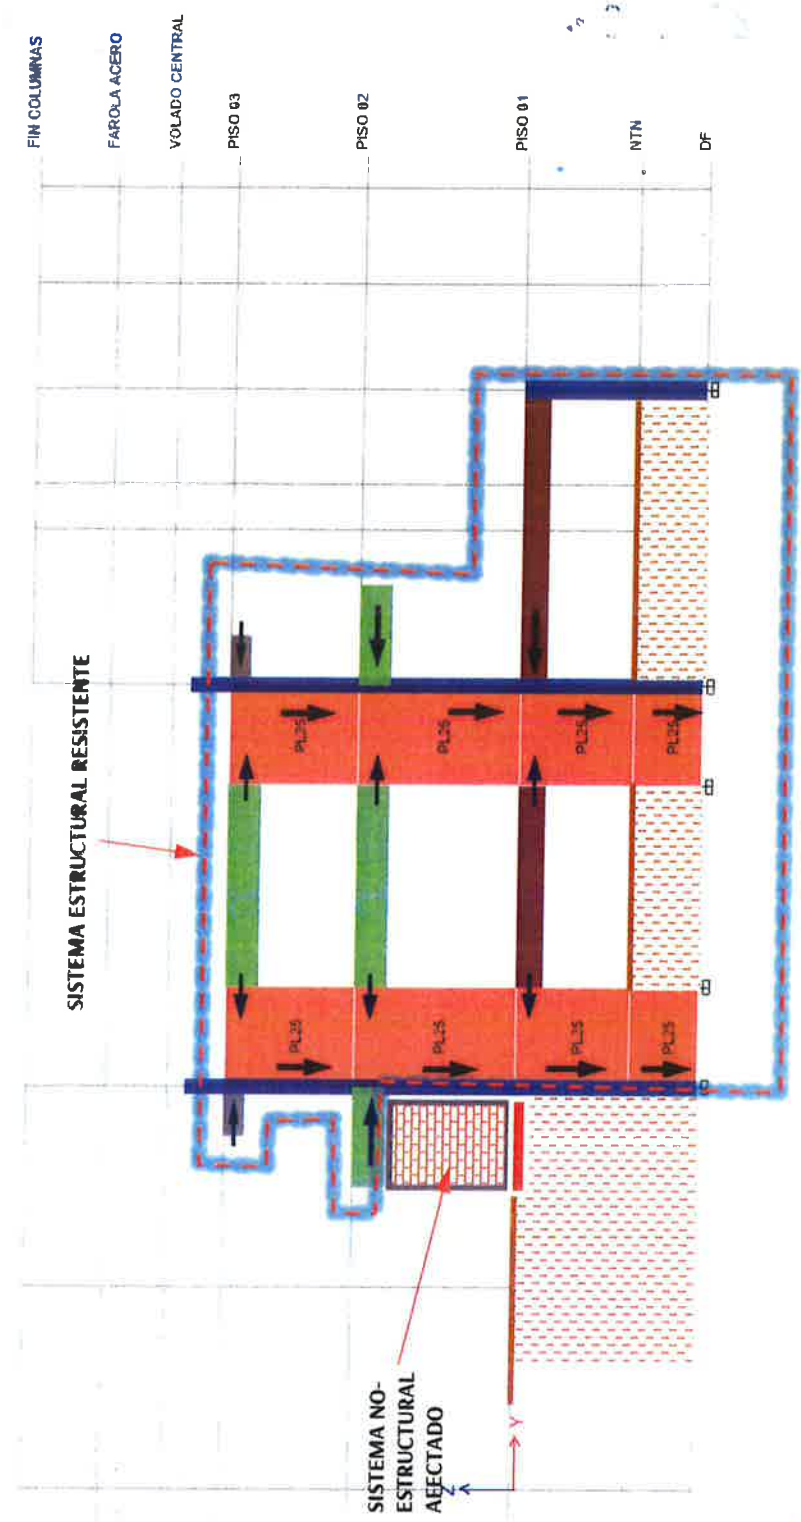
Transferencia de cargas en el EJE E-E. El sistema estructural resistente del edificio central y las zonas afectadas (muros de mampostería) se encuentran trabajando independientemente uno del otro.
